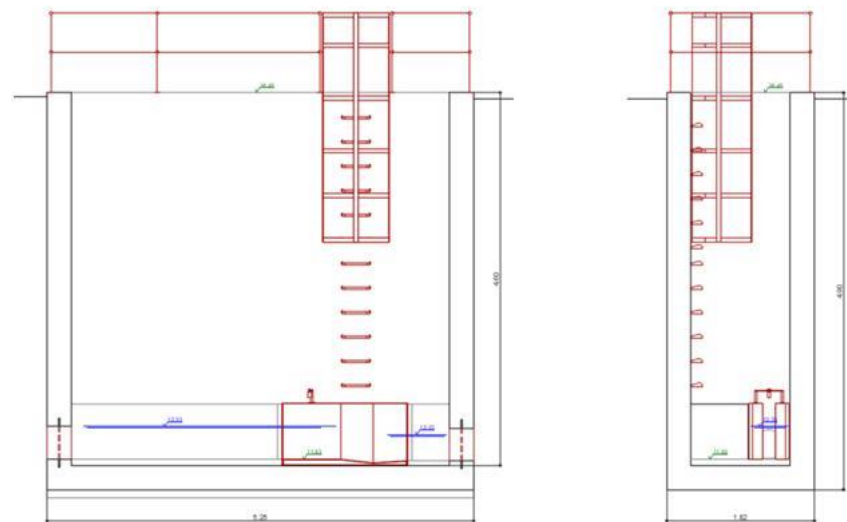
Secciones del canal Parshall (sección A-A' a la izquierda y sección B-B' a la derecha)
